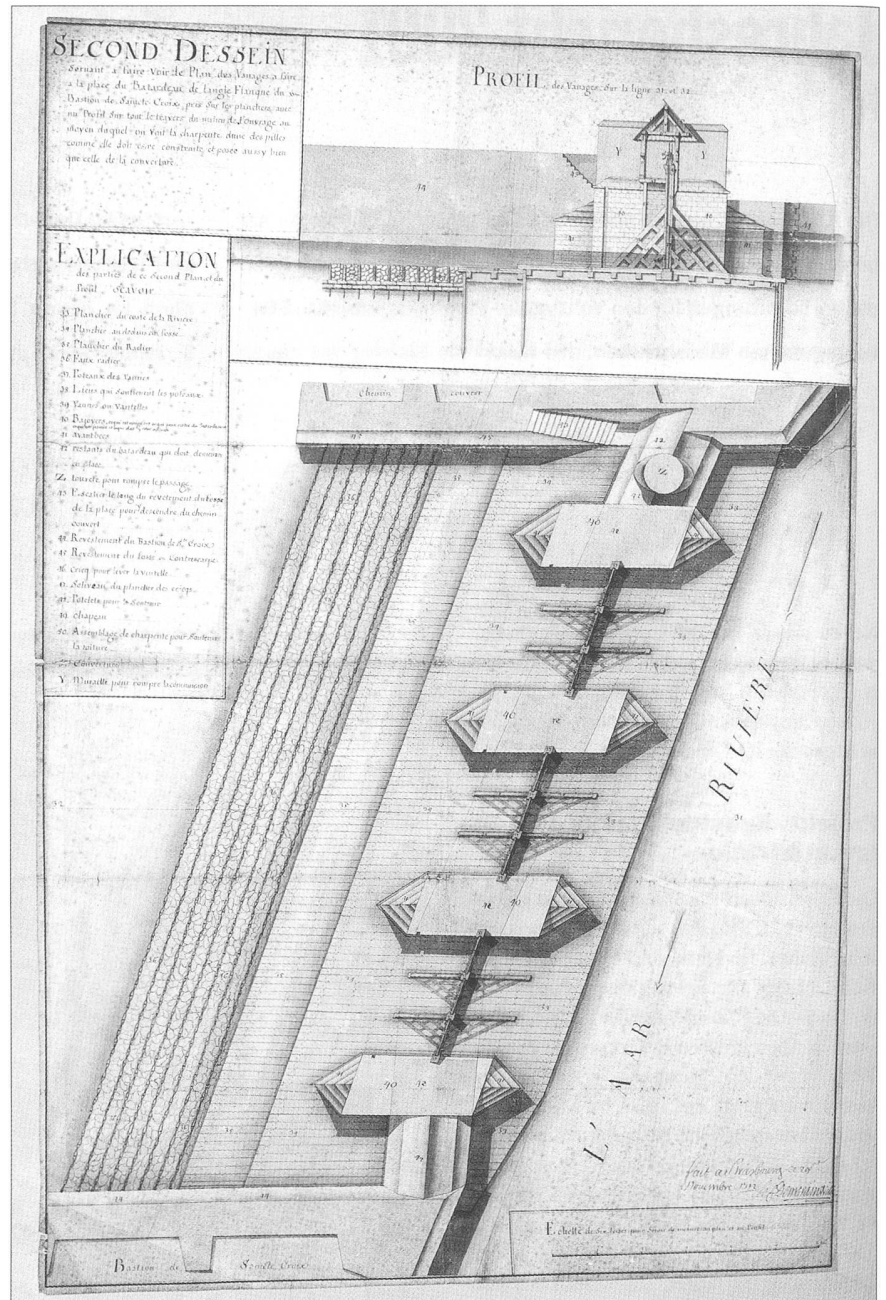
Grundriss und Schnittplan zur Errichtung einer Schleuse beim Krummturm.
